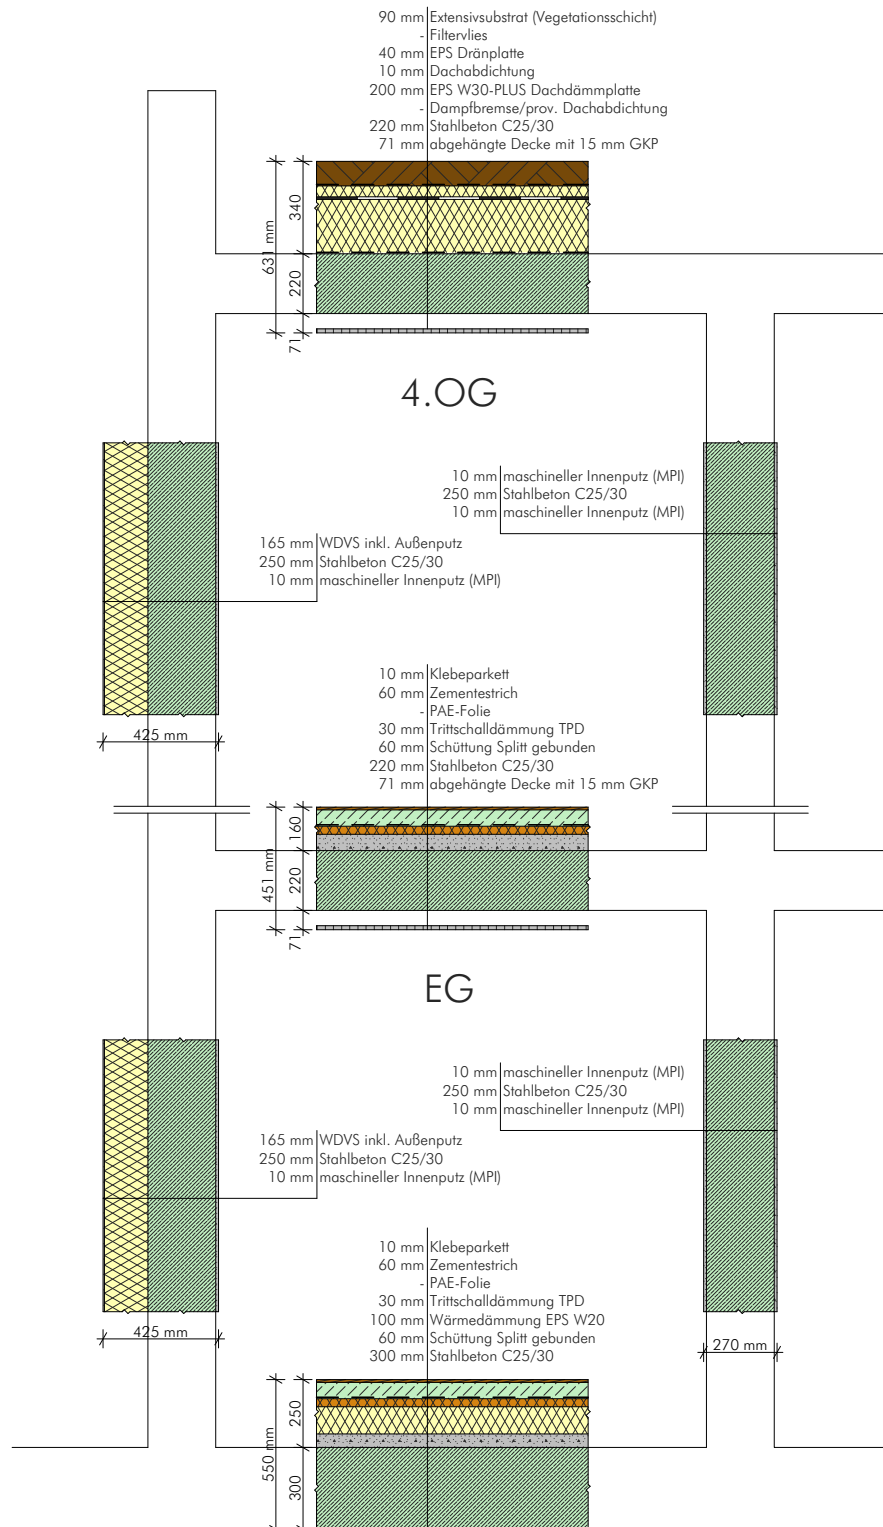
Situierung der Bauteilaufbauten anhand eines Fassadenschnittes
